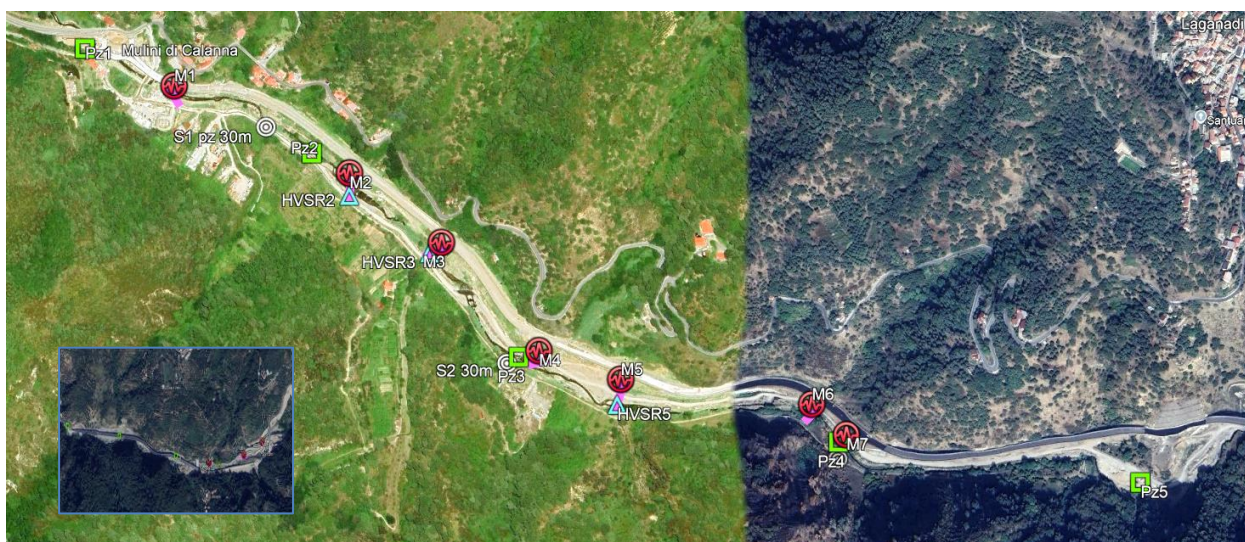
Planimetria su ortofoto con ubicazioni delle indagini eseguite: tratto di valle.
